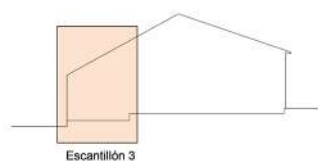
Escantillón de invernadero y muro de la fachada norte en el refugio para guardaparques
